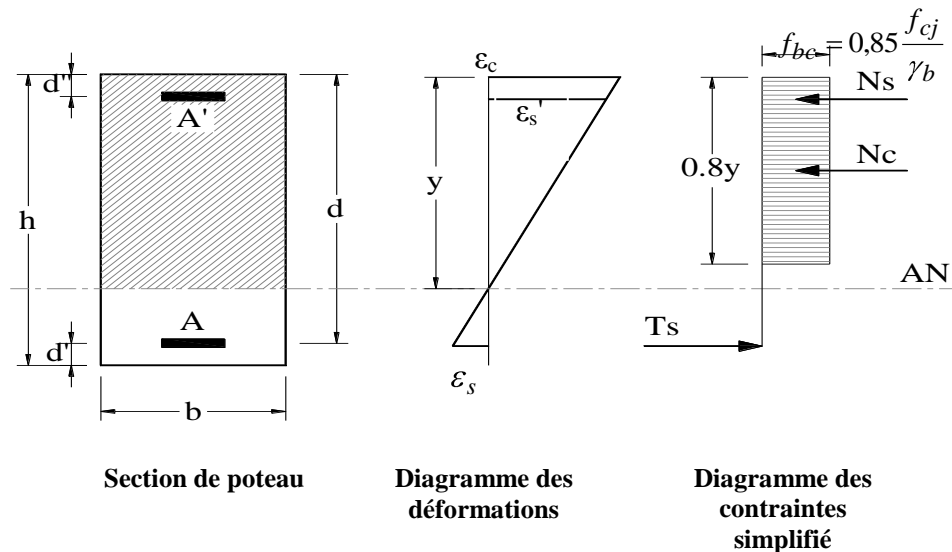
Section rectangulaire ferrillée avec deux nappes d'armature (section partiellement tendue ou comprimée)
